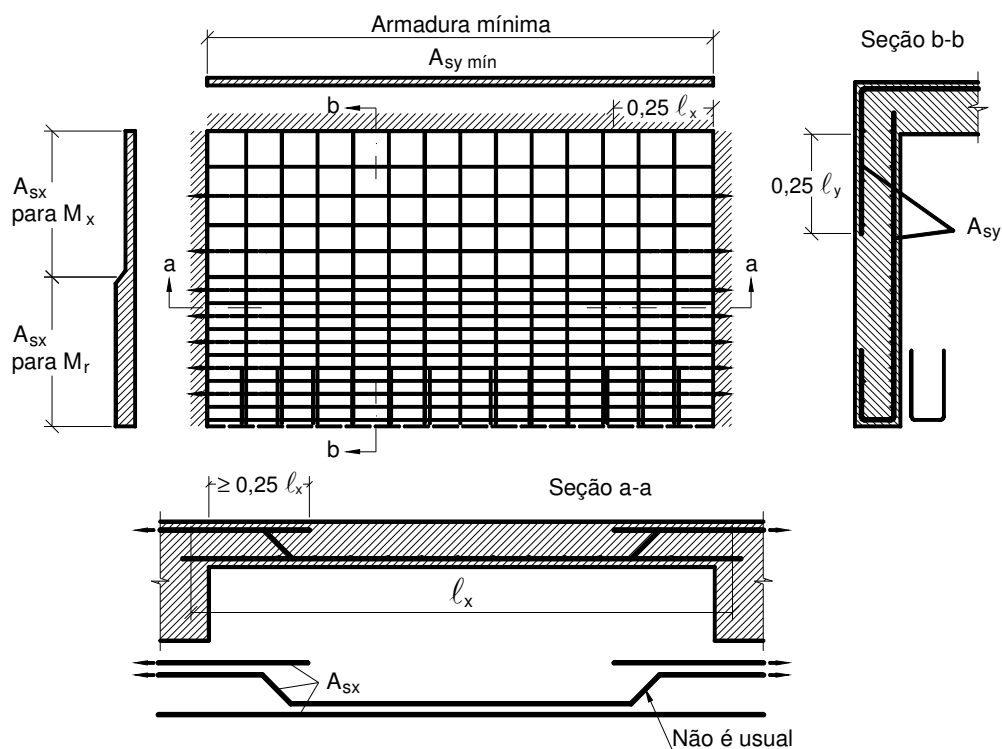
Armadura inferior de laje retangular apoiada em três lados engastados com carga uniforme.
